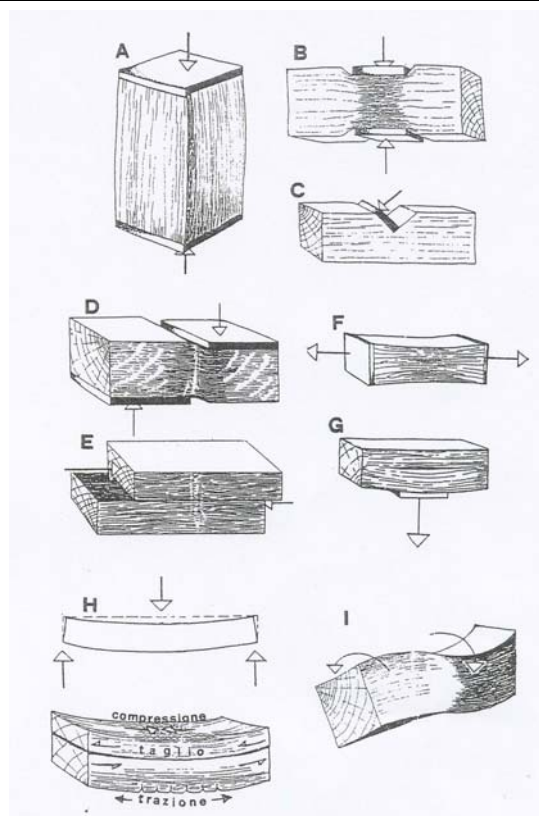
Sollecitazioni rispetto alla diversa orientazione della fibra
